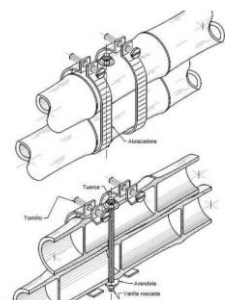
Abraçadeiras para estabilizar ligações aparafusadas (Ministerio de Ambiente, V.y.D.T.-R.d.C., 2012)
